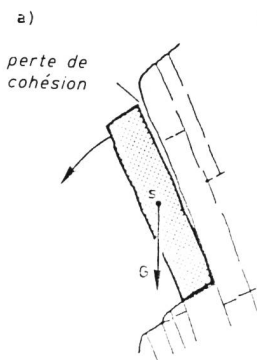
Autorégénération de parois verticales par fissuration aux pieds (voir text).
